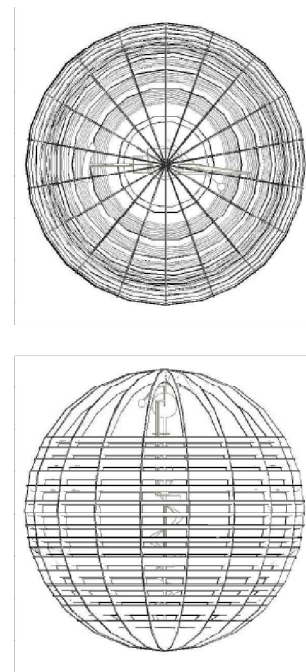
Planta y alzado. Elaboración propia.
